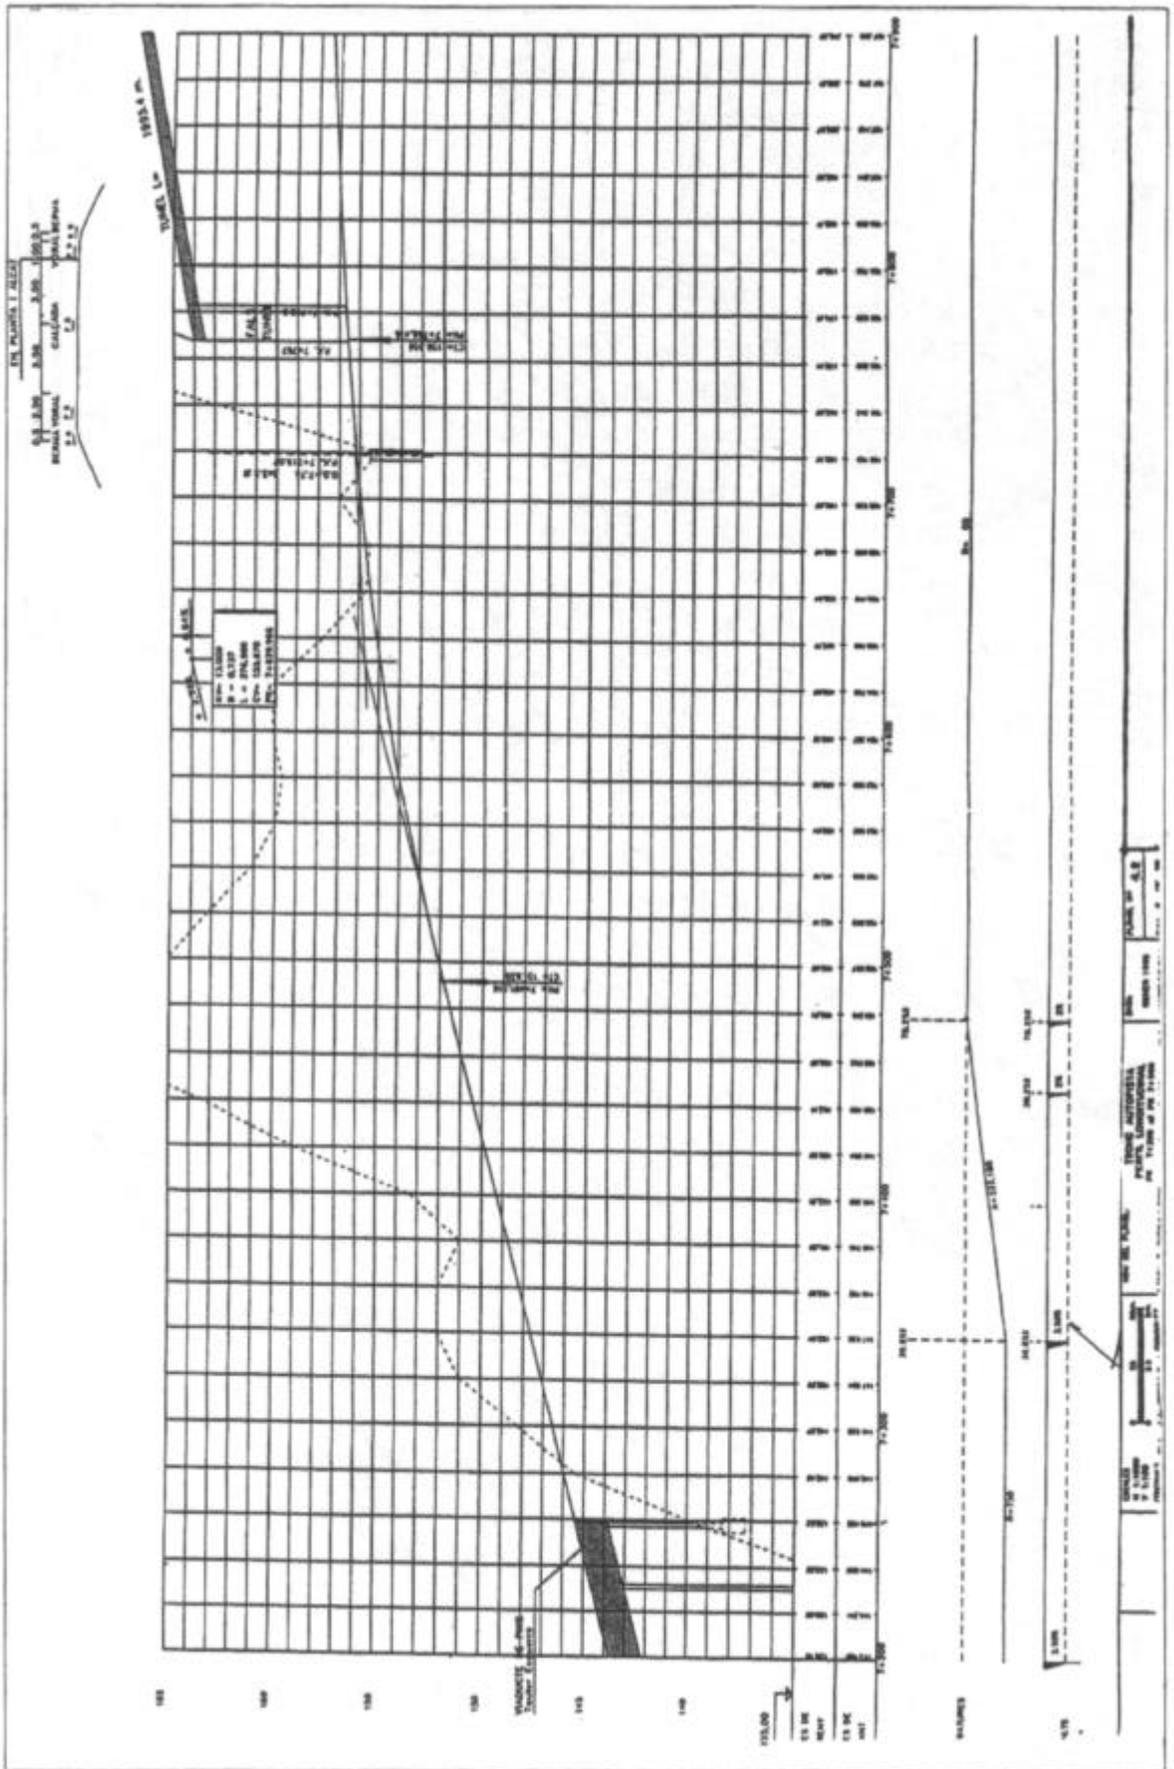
Perfil longitudinal (Proyecto Autopista)
